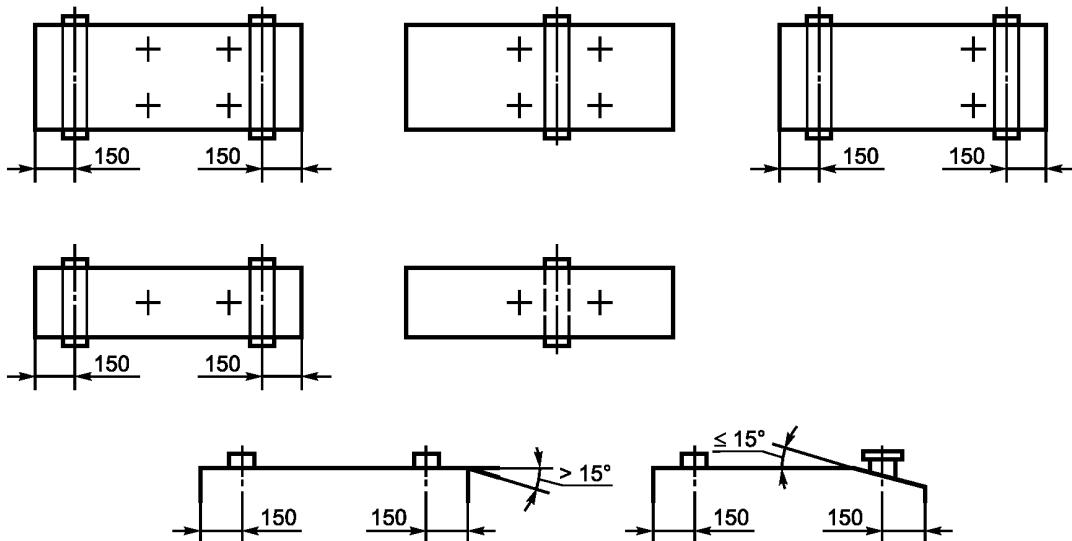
Схемы нагружения перекрытий при испытании на изгиб
